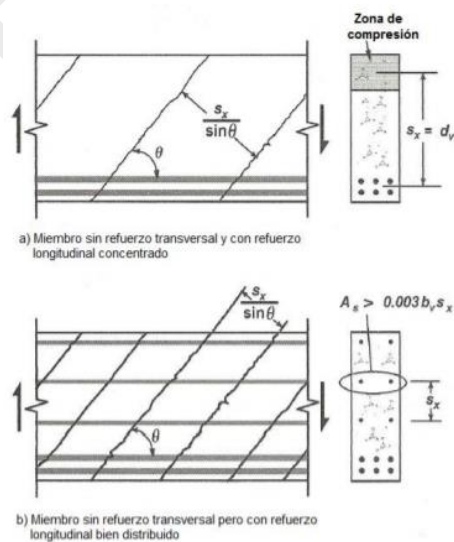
Definición del Parámetro de Espaciamiento de Grietas, s_x
